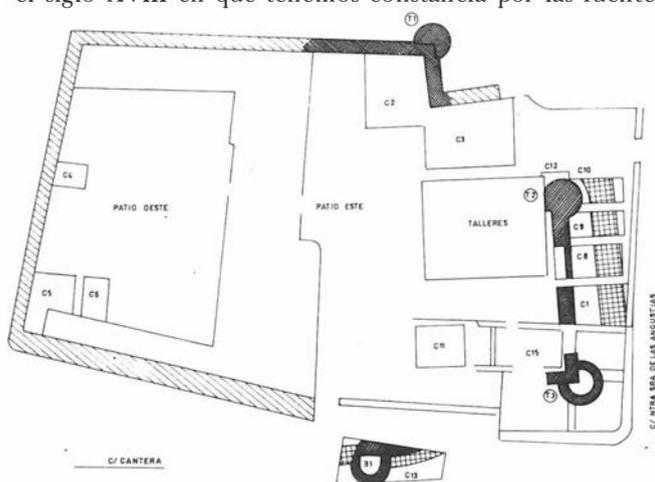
Croquis planimétrico. Estructuras y lienzos de fortificación.
